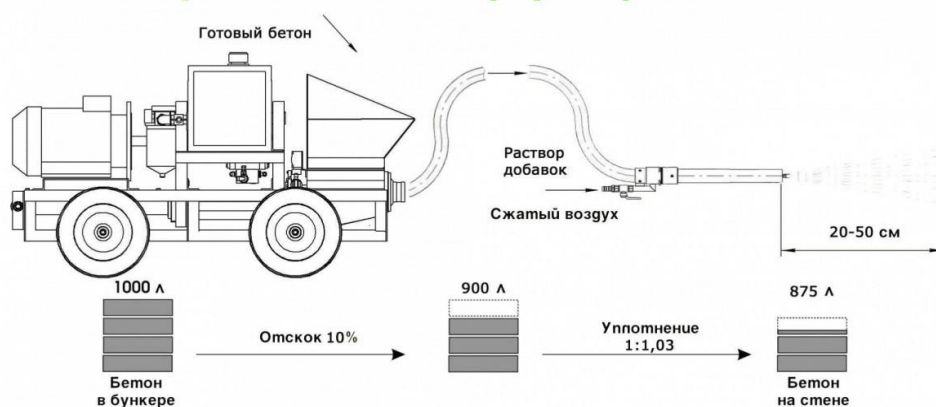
Оборудование для возведения торкрет бетонной крепи
